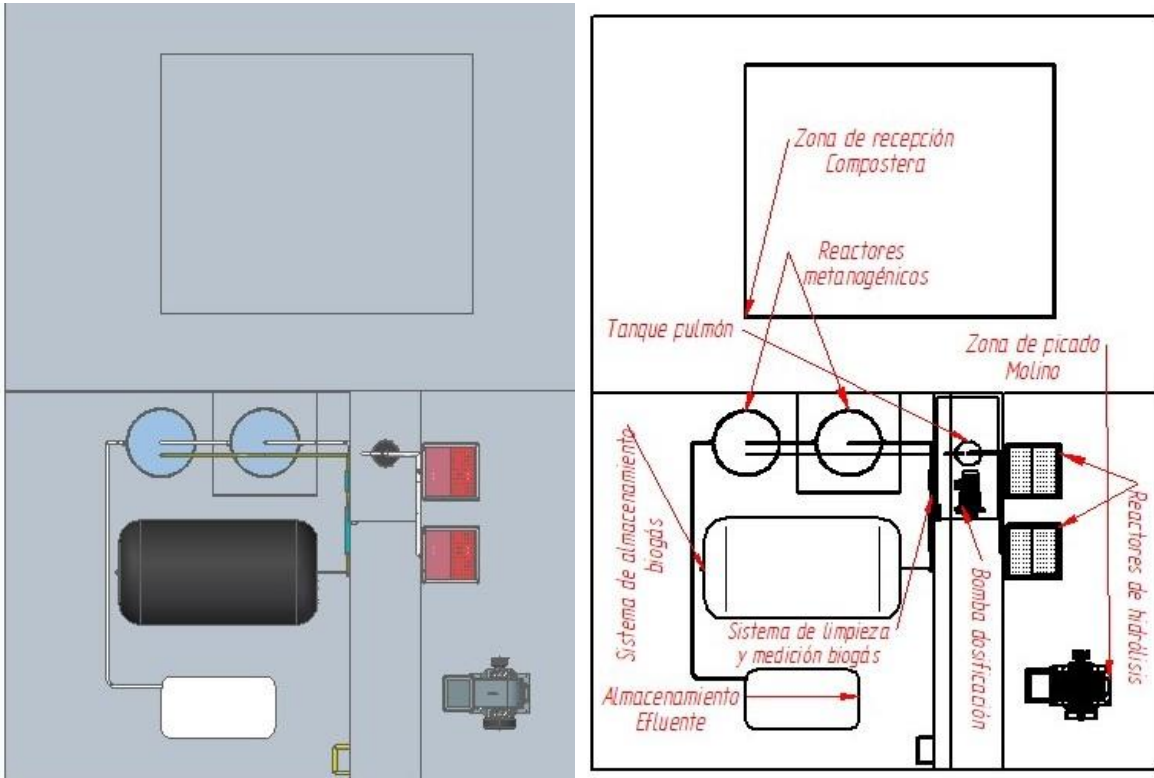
Esquema del sistema de digestión anaerobia instalado – vista en planta
